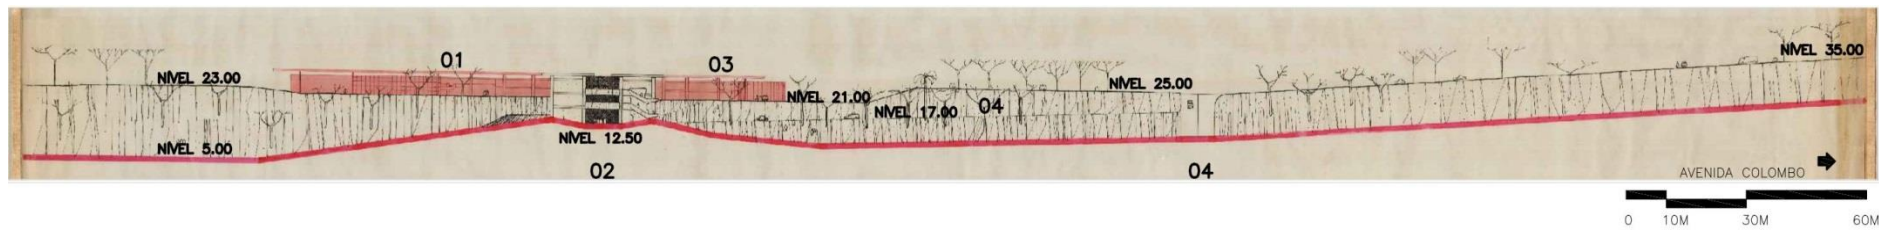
Elevação Oeste Plano UMA. Fonte: Pranchas 09 e 10 do Plano de Implantação Imediata – 1º Sub-Etapa Plano UMA – Arquivo digital disponível no COMCAP-UEM.
